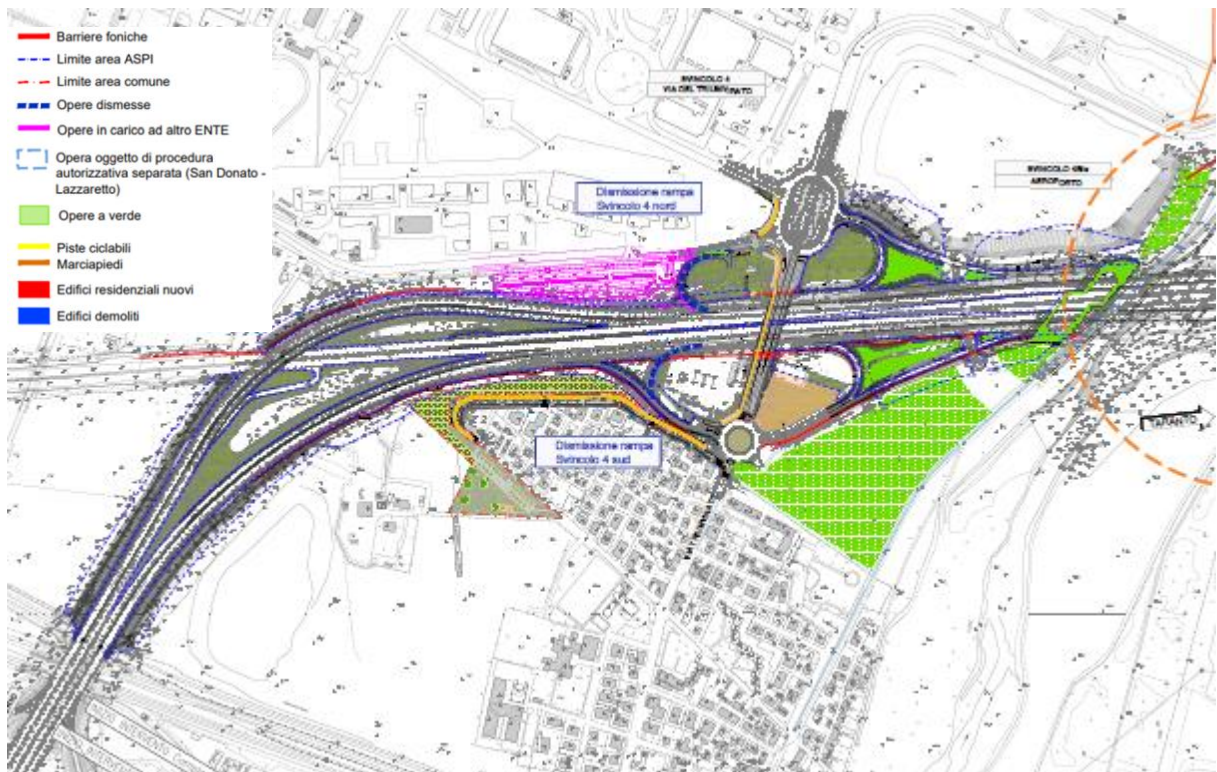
Planimetria di raffronto fra lo stato attuale e lo stato iniziale
